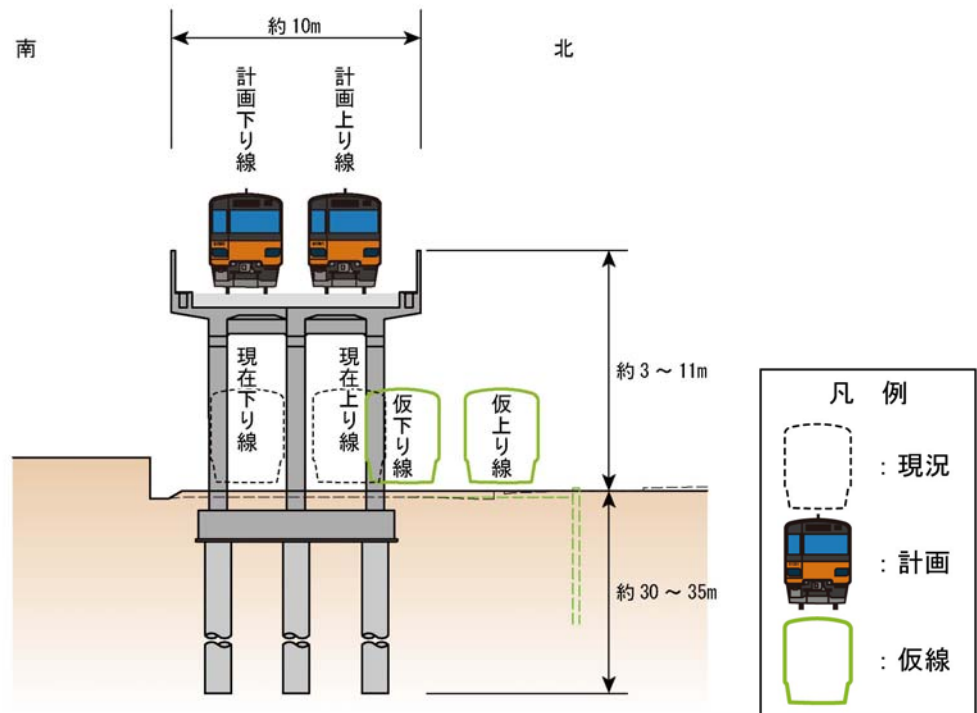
(2) 一般部標準断面図(高架橋区間(b-b断面))
